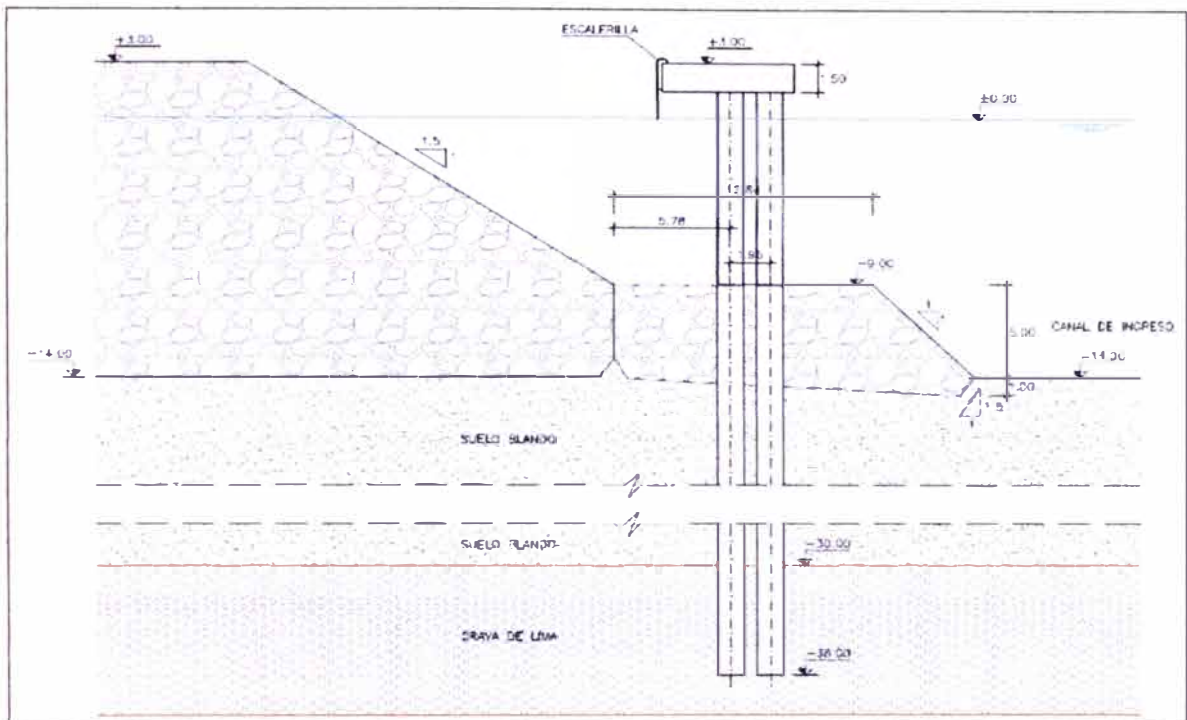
Sección con pilotes y banqueta de enrocado
